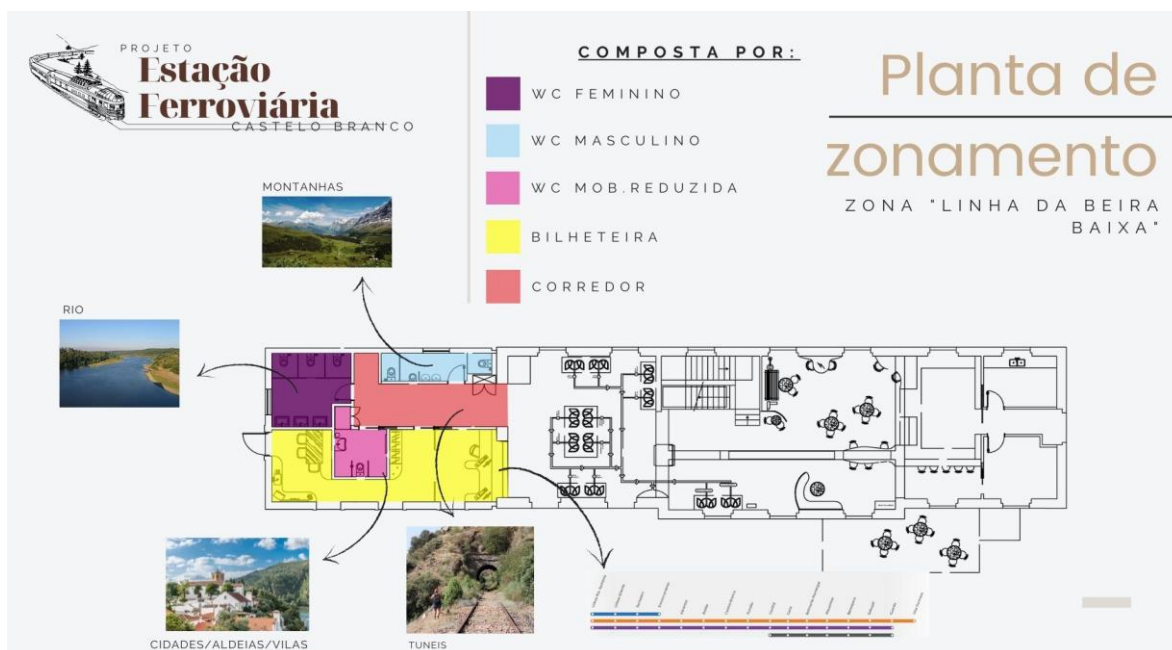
Planta de Zonamentos coloridas, zona “ Linha da Beira Baixa
